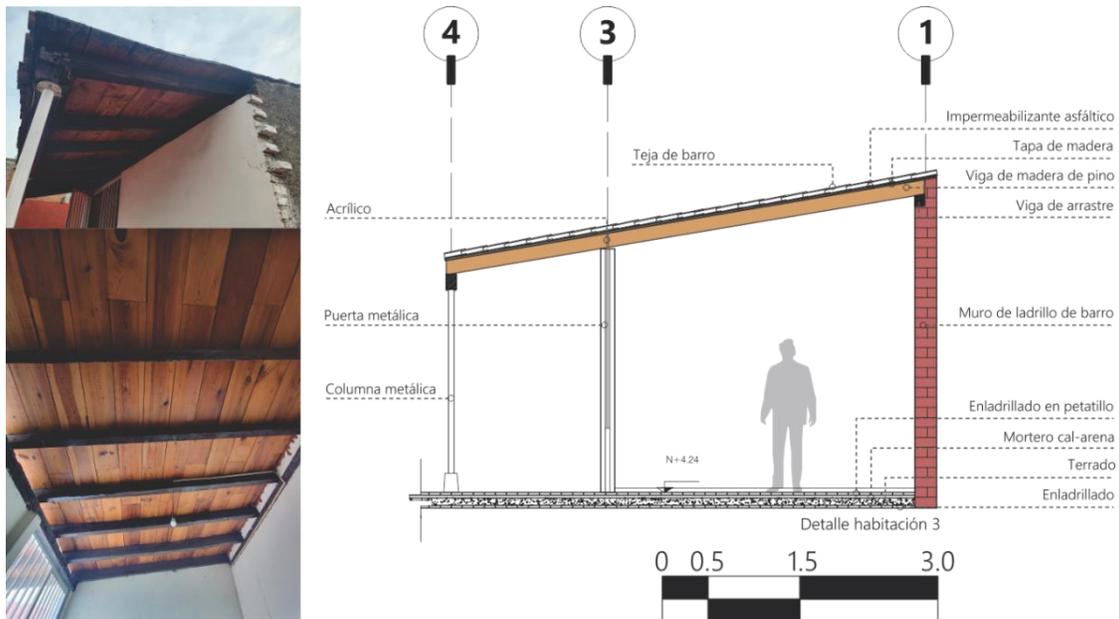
Detalle de habitación 3 donde se muestra la cubierta. Fotografías y elaboración por KNV.
